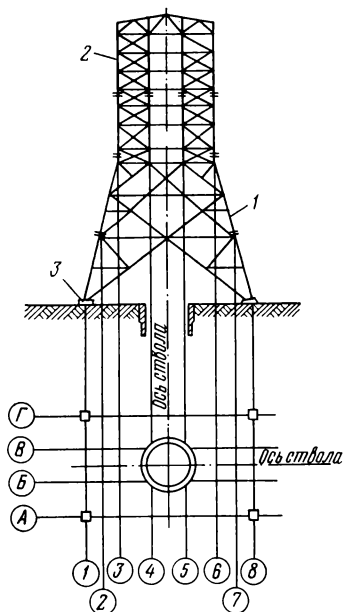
Схема металлического башенного копра с наклонными опорными стойками
